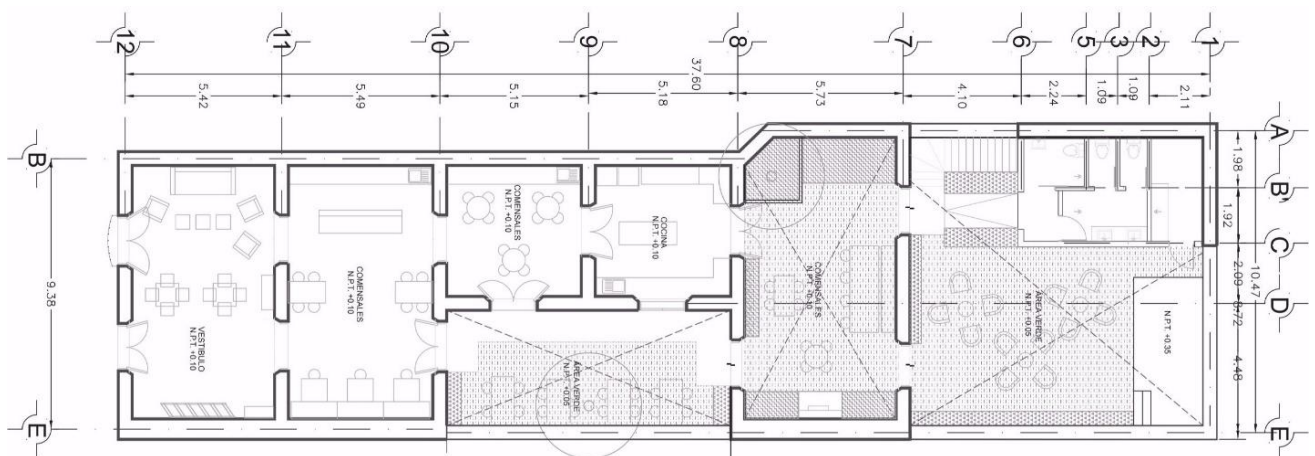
Planta arquitectónica. © Nauzet Rodríguez
